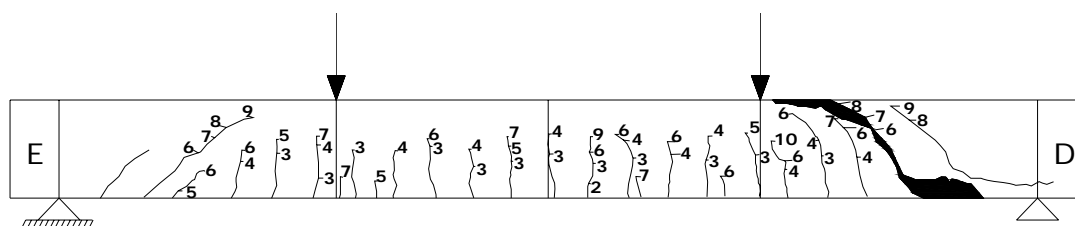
Padrão de fissuração para a viga V90-2 com armadura transversal
